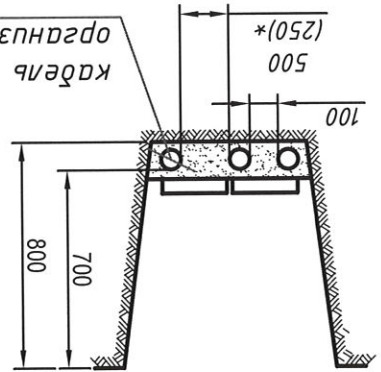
Прокладка кабелей рядом с опорой ВЛ
